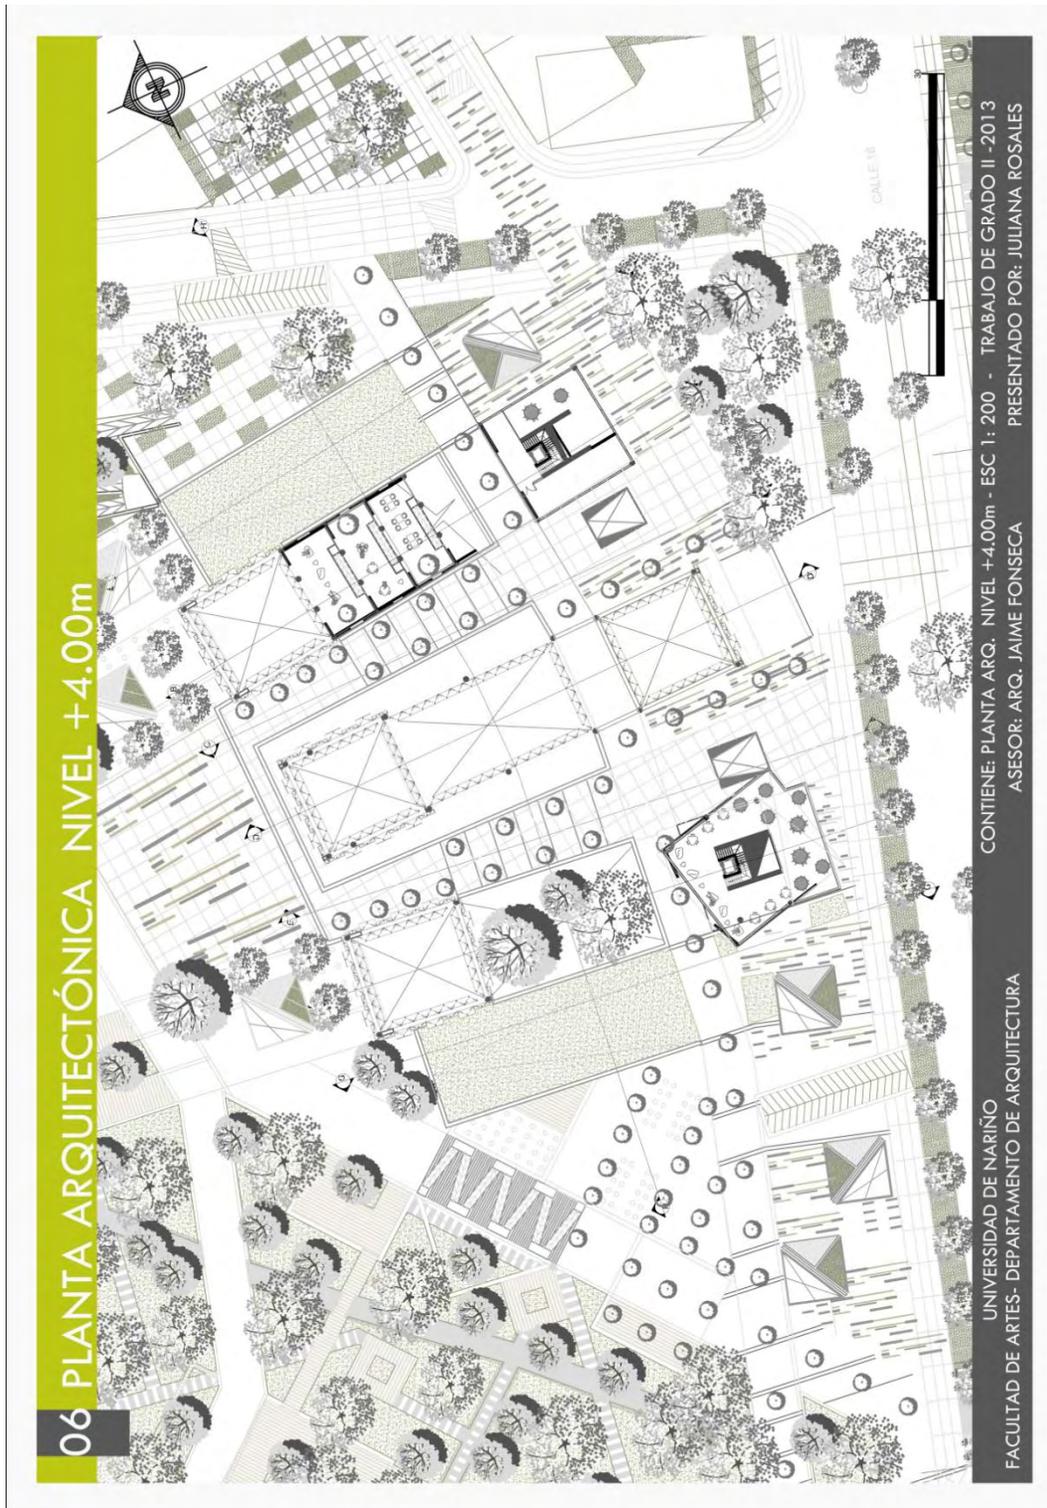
Proyecto_ Planta nivel +4.00m // Fuente esta investigación
